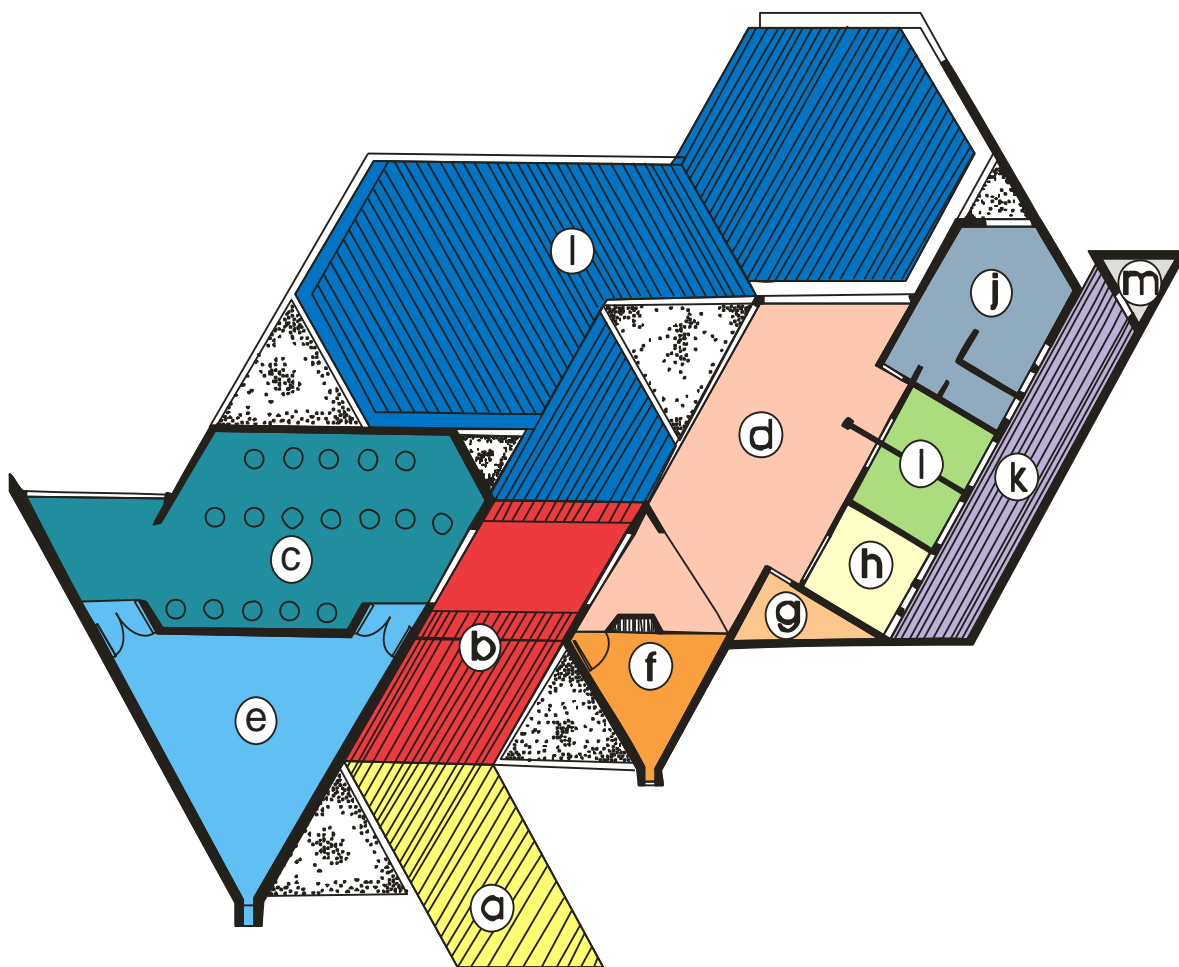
Vista en planta del Centro de interpretación y sus instalaciones.
